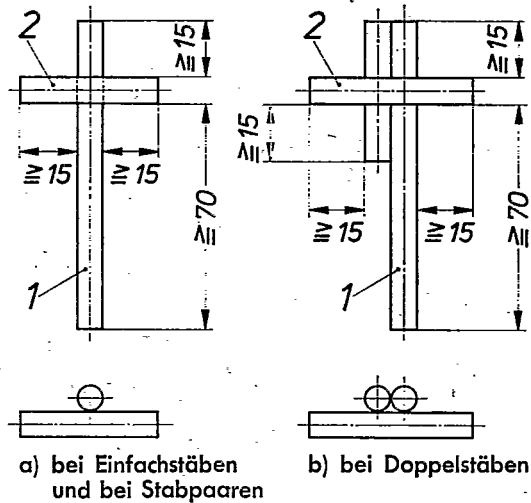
a und b. Scherproben von geschweißten Betonstahlmatten. (Maße in mm)
